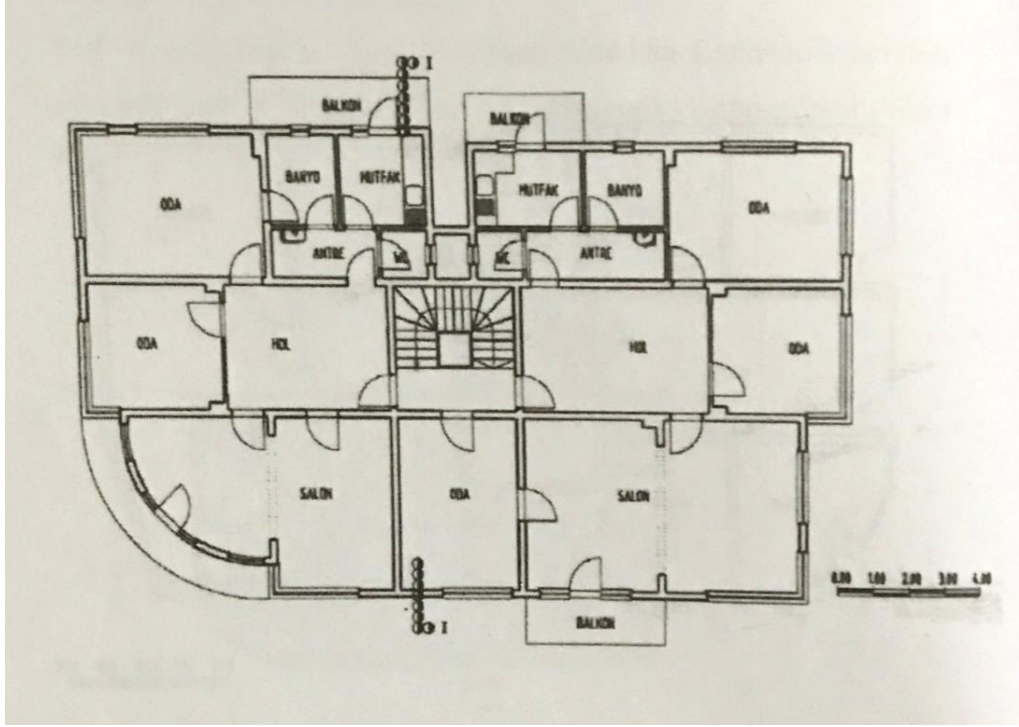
Adalı Apartmanı Planı (Müştak, 2016)
